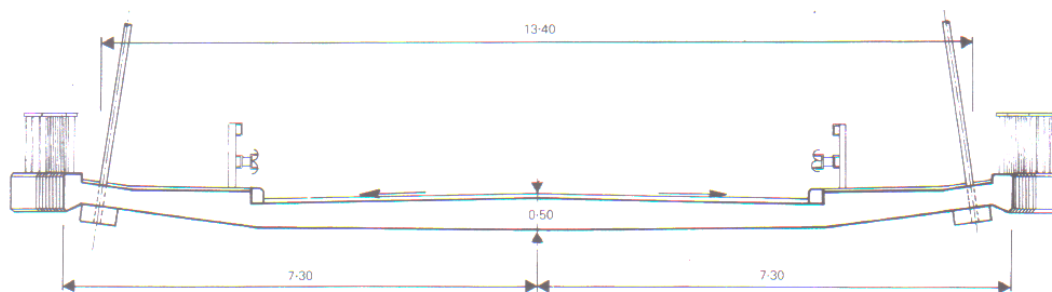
Seção maciça de concreto - Projeto de Ponte sobre o Rio Dala. Suíça (não executado) (WALTHER et al, 1999)
